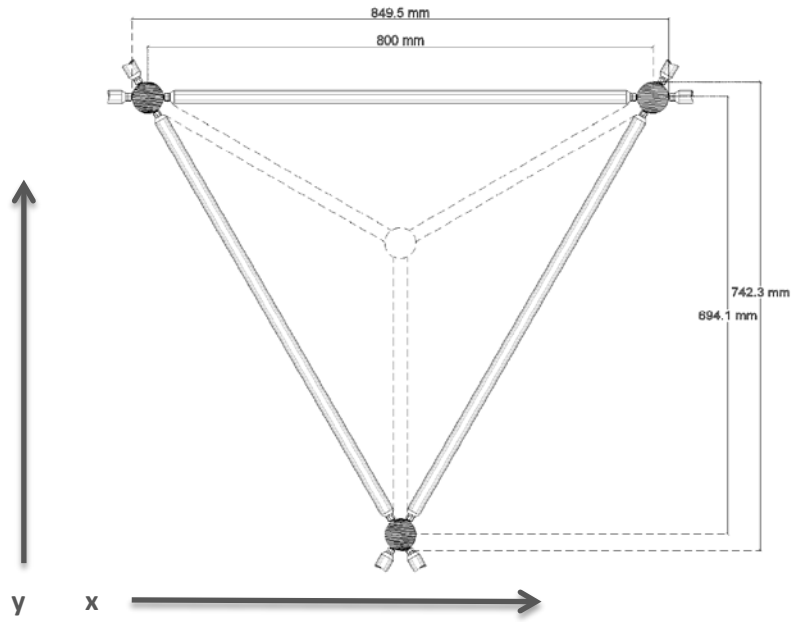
Vista en planta del núcleo tetraédrico con las dimensiones establecidas para el proyecto, según el cálculo de barras de 75.5 cm de longitud.
